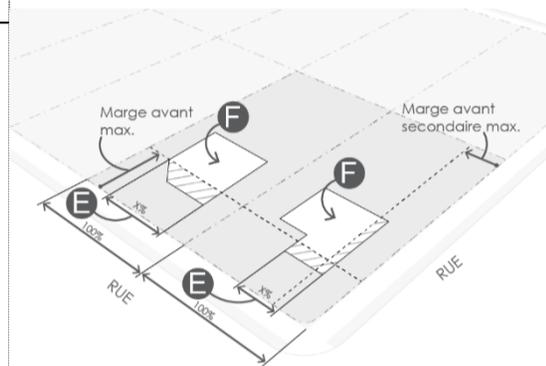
Front bâti et superficie d'implantation au sol d'un bâtiment
